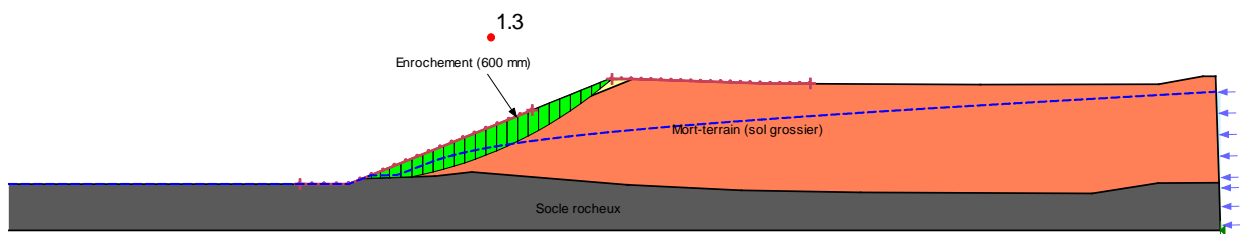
Stabilité pseudostatique, excavation dans des sols grossiers
